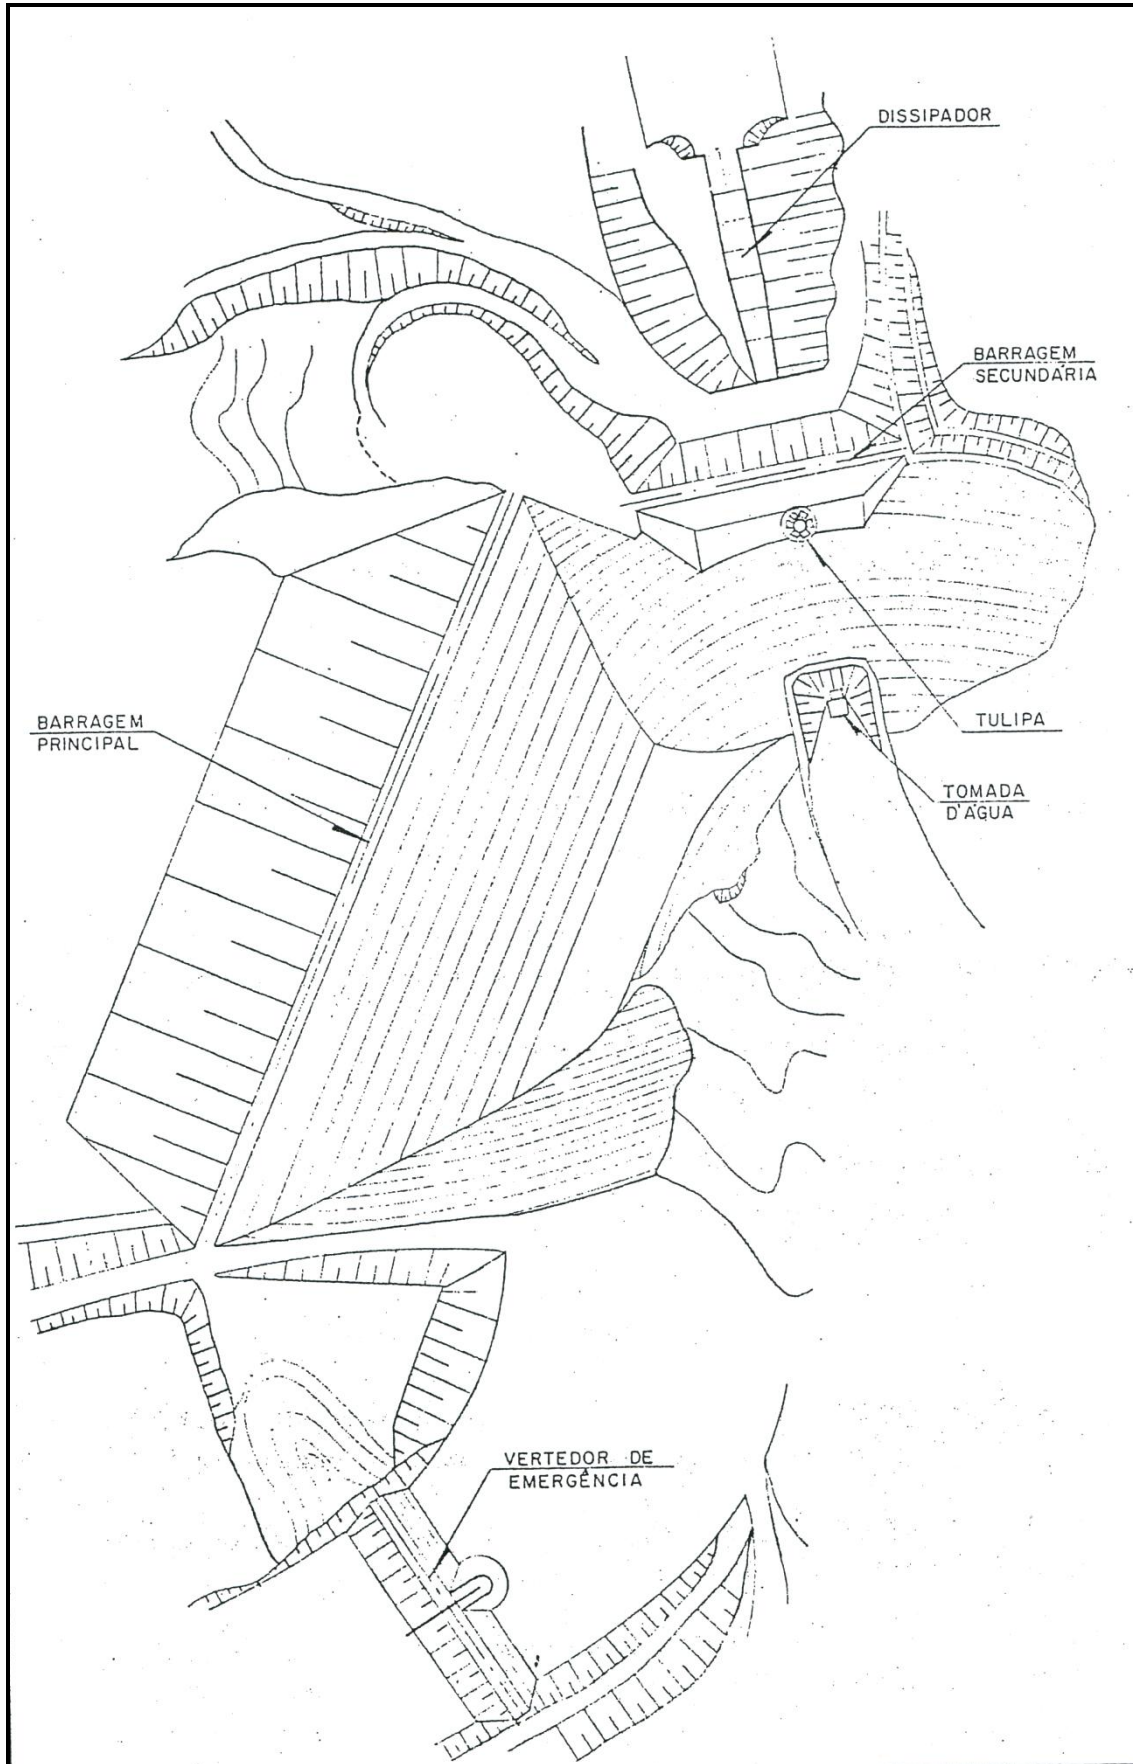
Barragem de Chapéu D'Uvas (planta geral)
